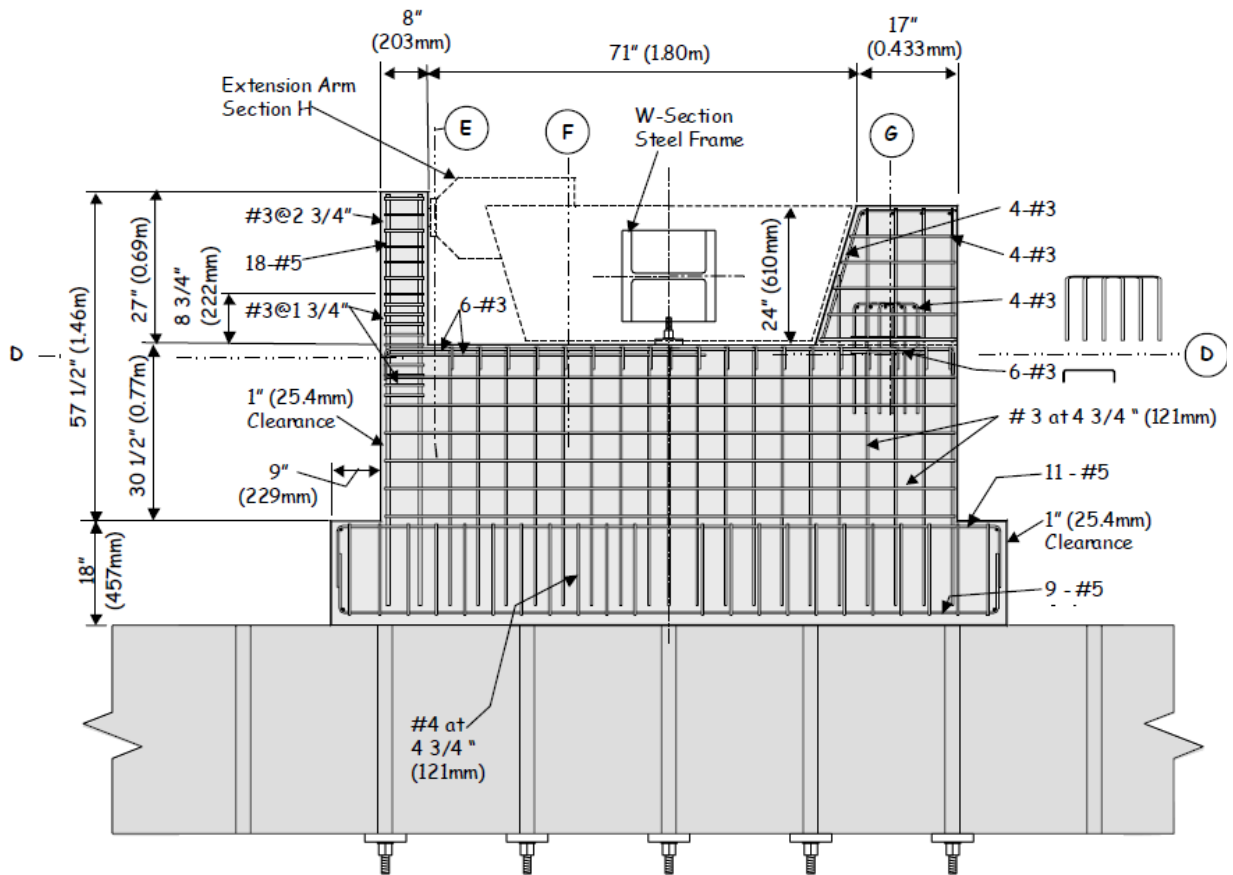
Vista en Elevación de Refuerzos – Serie 2 Externa (Megally et al., 2002).
